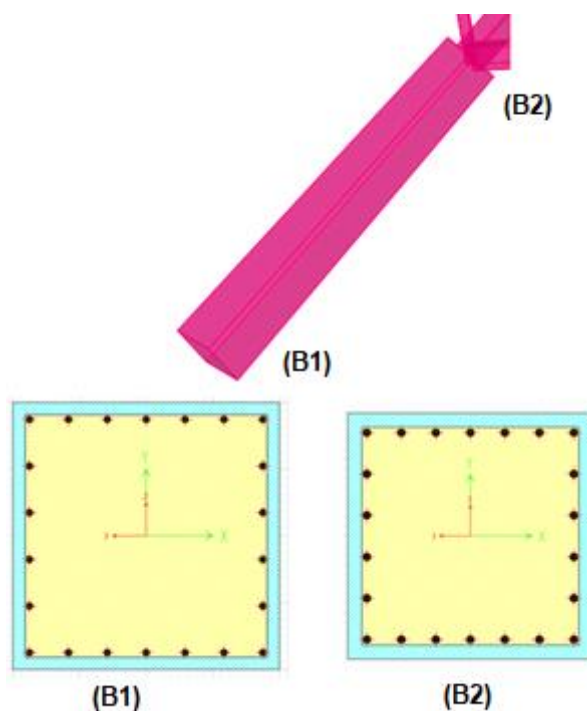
Secciones en el elemento 01 columna inclinada desde la base hasta la intersección con las vigas inclinadas rectangular (B1) 1m x 1m y (B2) 0.8m x 0.8m.
